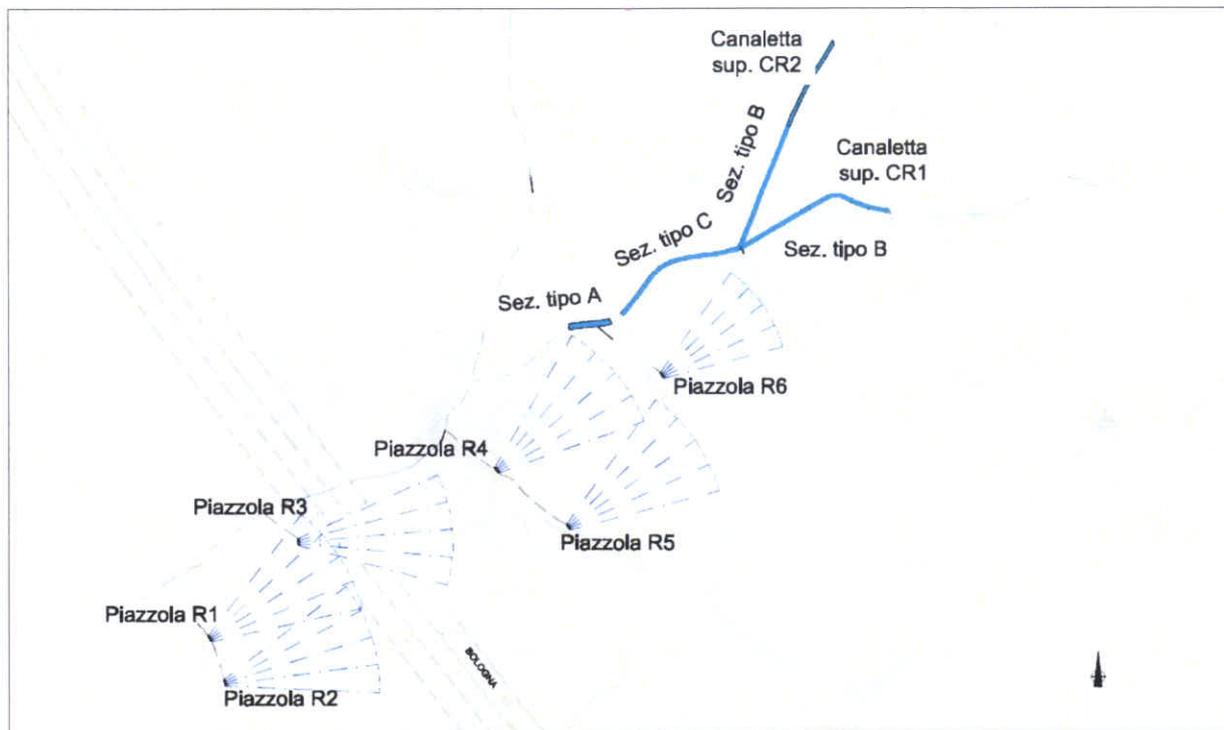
Area “Roncaglie” – estratto Planimetria di progetto (GEN IDR03 00 PL 002R – R01V).
